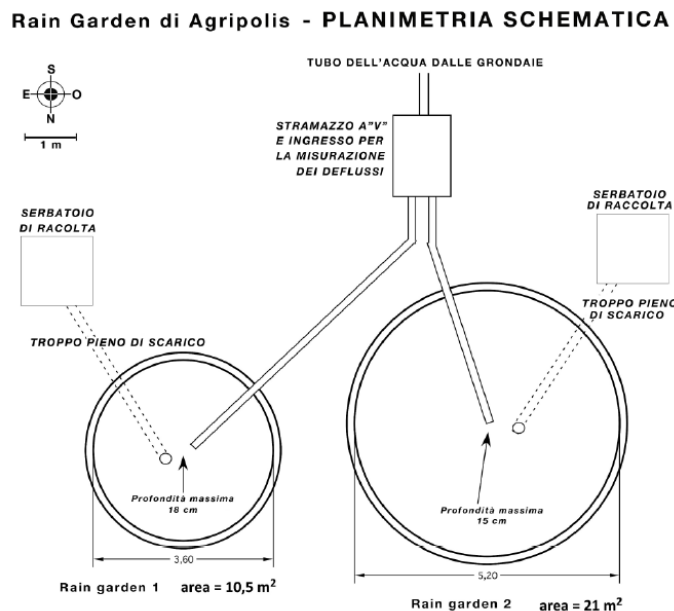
Planimetria schematica del sistema per la misurazione dei deflussi (Simionato 2011).
